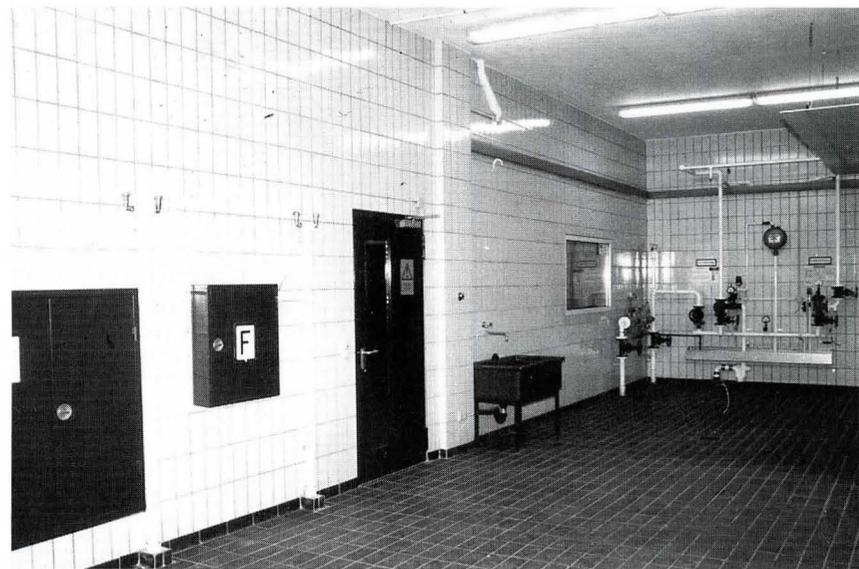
Brandbekämpfungsraum mit Ventilstation für Sprinkleranlage und mit Wandhydrantenschranken
